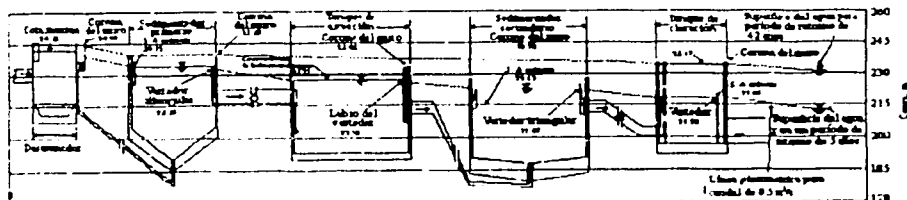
Perfil Hidráulico de una planta de Tratamiento
